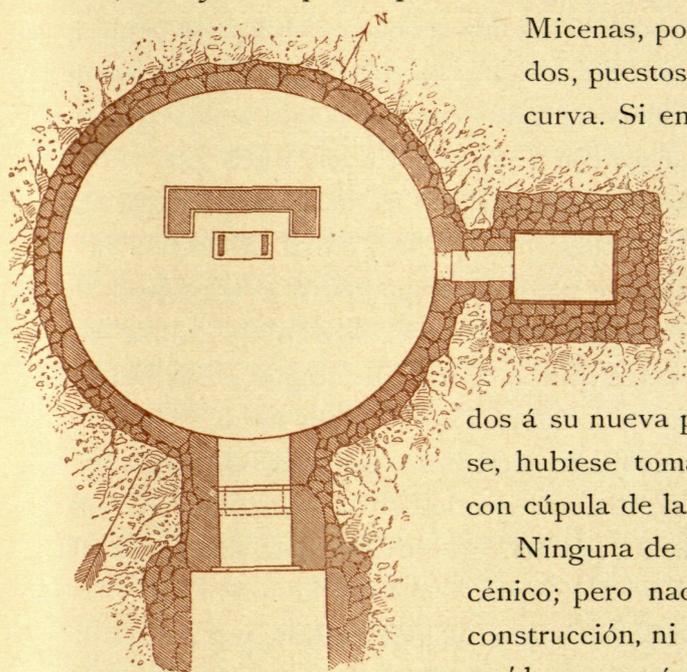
PLANTA DE LA TUMBA DE ORCOMENOS
